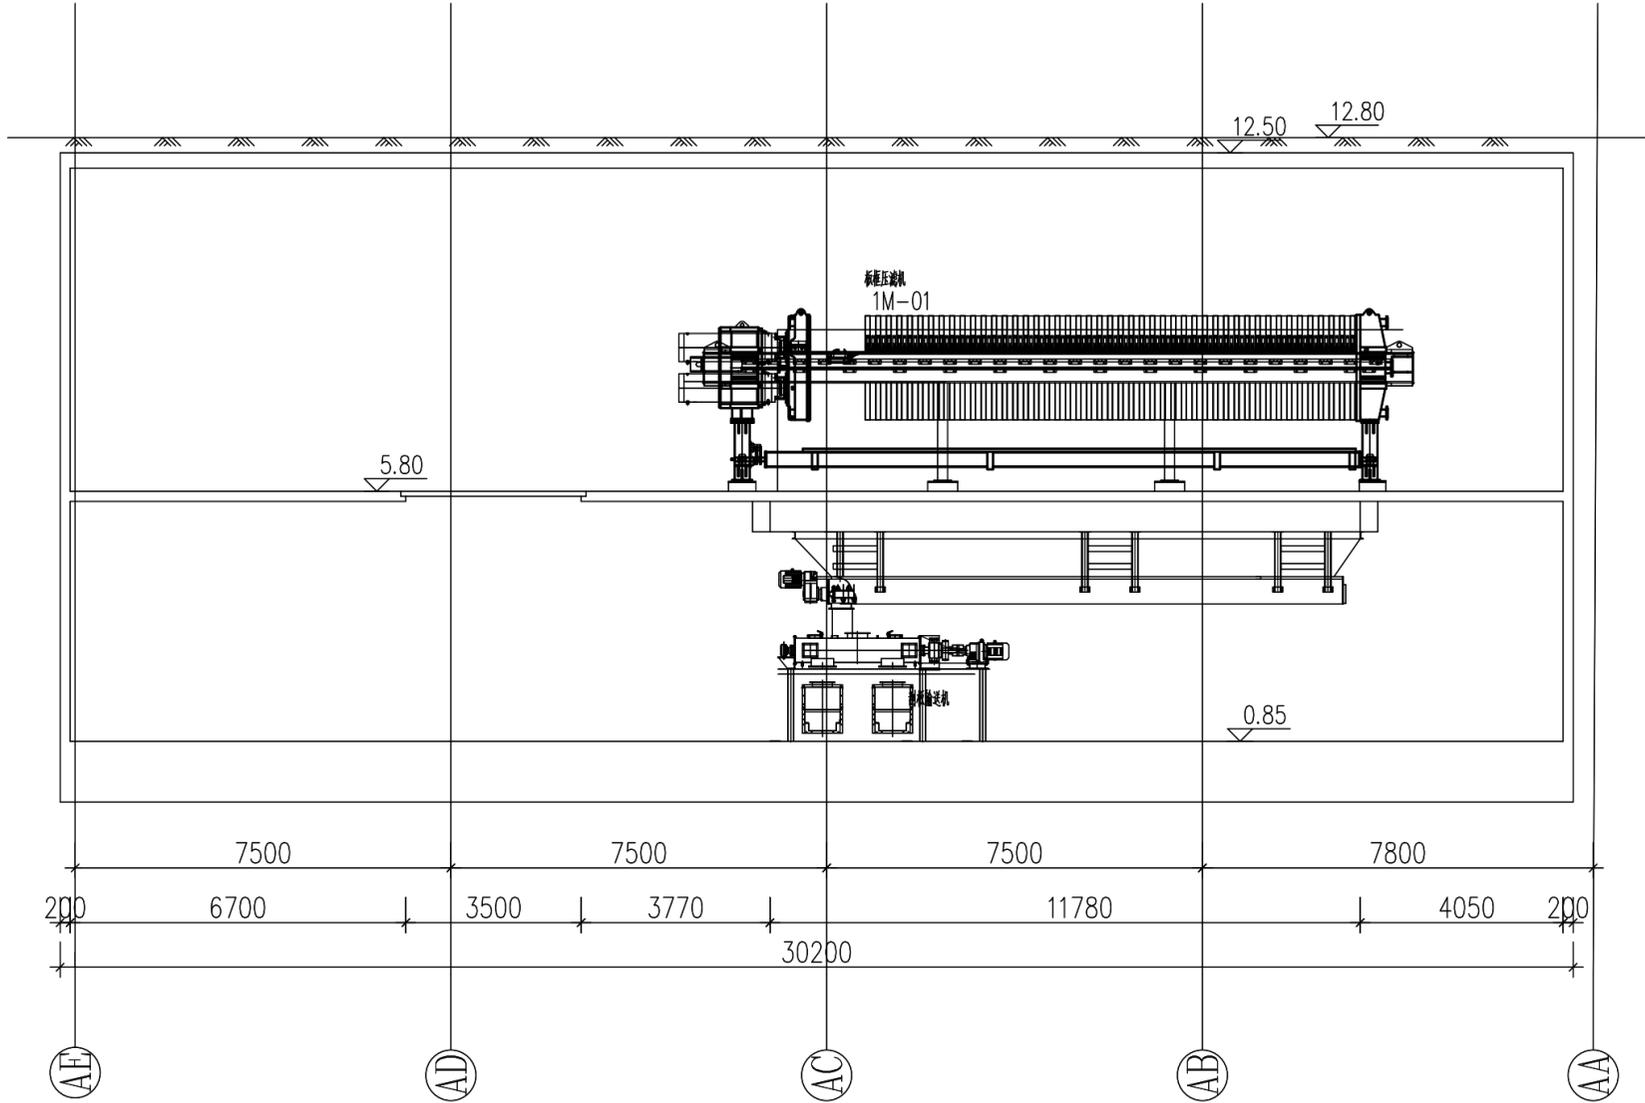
污泥脱水车间剖面图 (A-A 断面)
